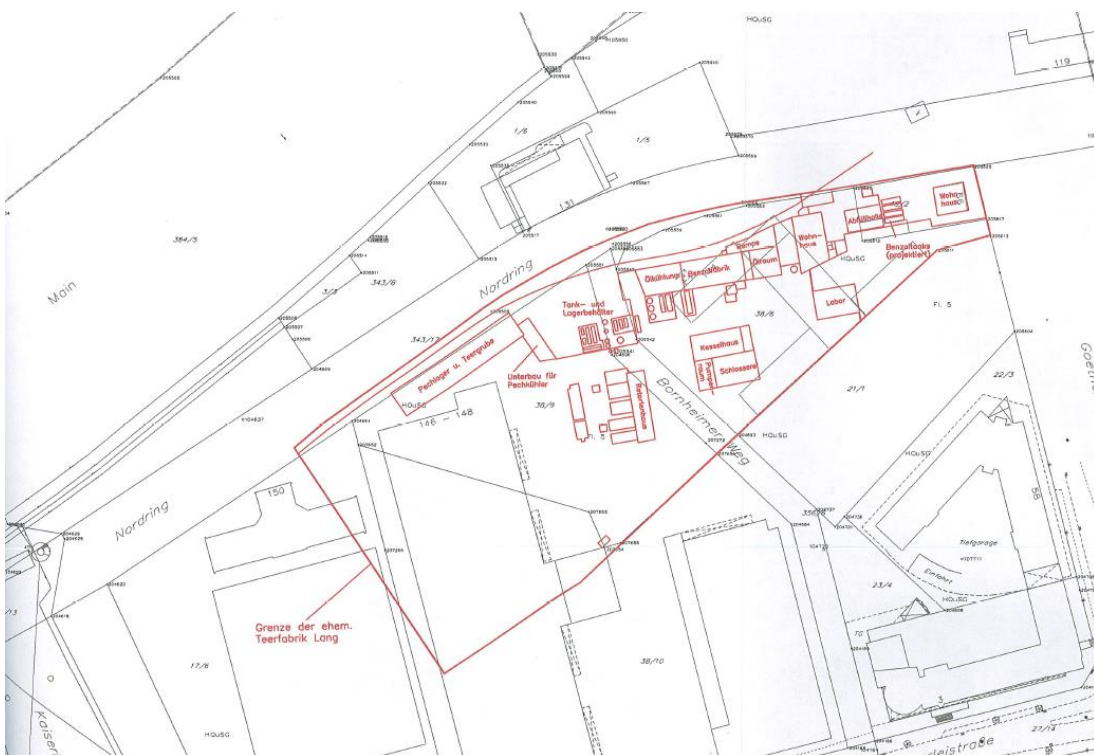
Ehemalige Teerfabrik Lang, Anlage 3 Rahmensanierungsplan – Lageplan der ehemaligen Betriebseinrichtungen (um 1928), CDM, unmaßstäblich
